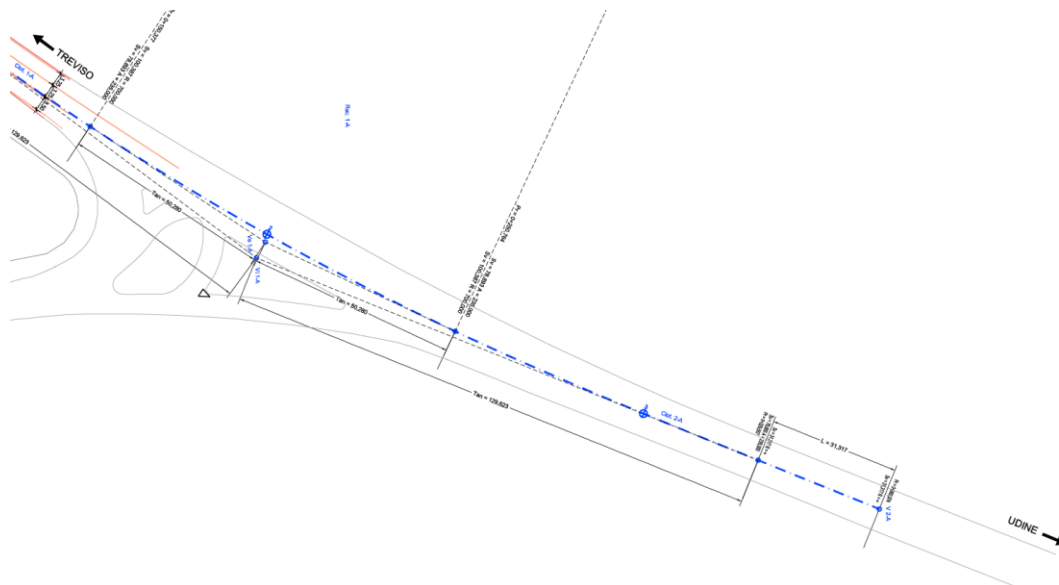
Andamento planimetrico riqualificazione tracciato S.S. n. 13
